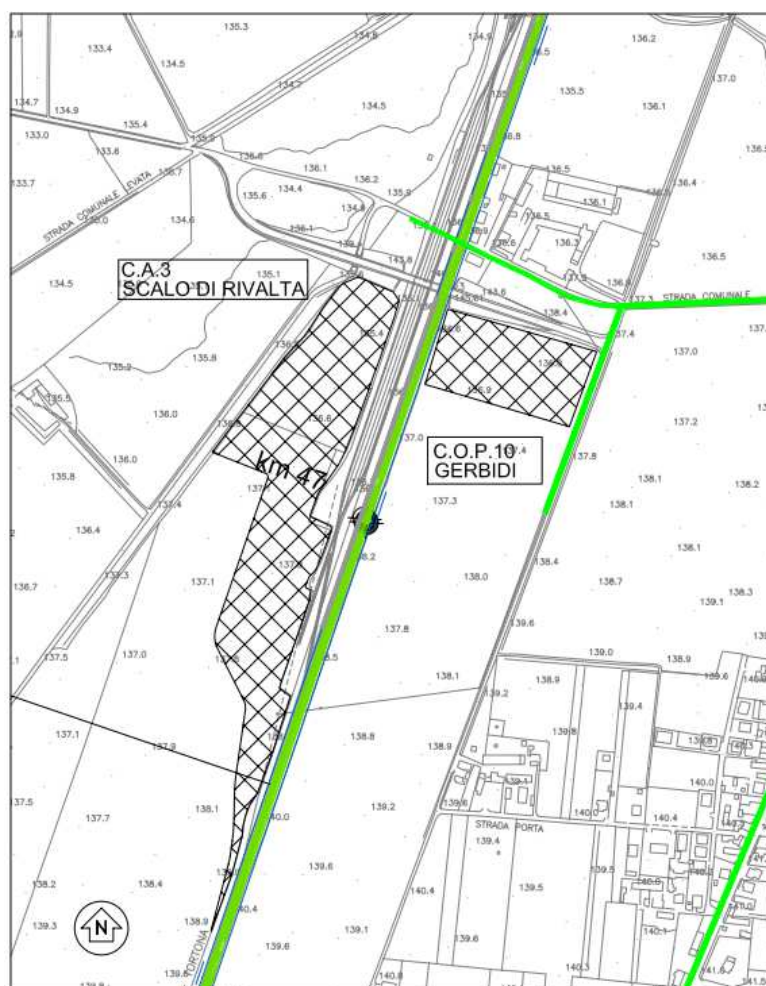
Stralcio planimetrico con indicazione dell'ubicazione del cantiere di Armamento C.A.3 per la soluzione di Progetto Definitivo
